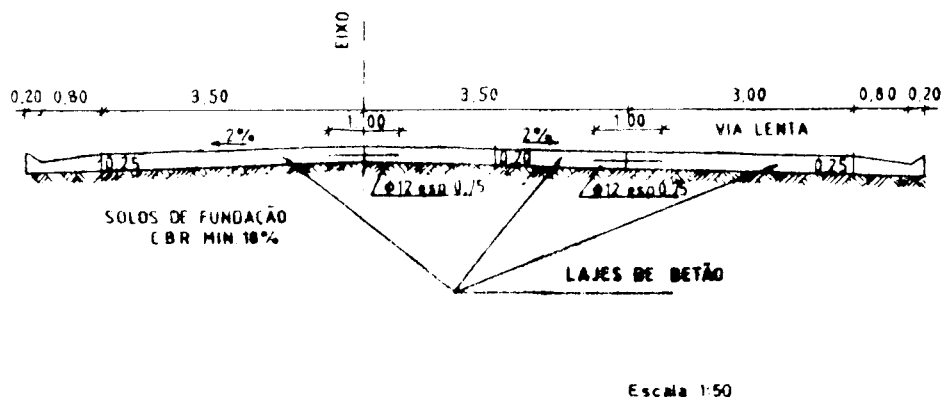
Perfil transversal-tipo em recta com a espessura preconizada para o pavimento rígido
